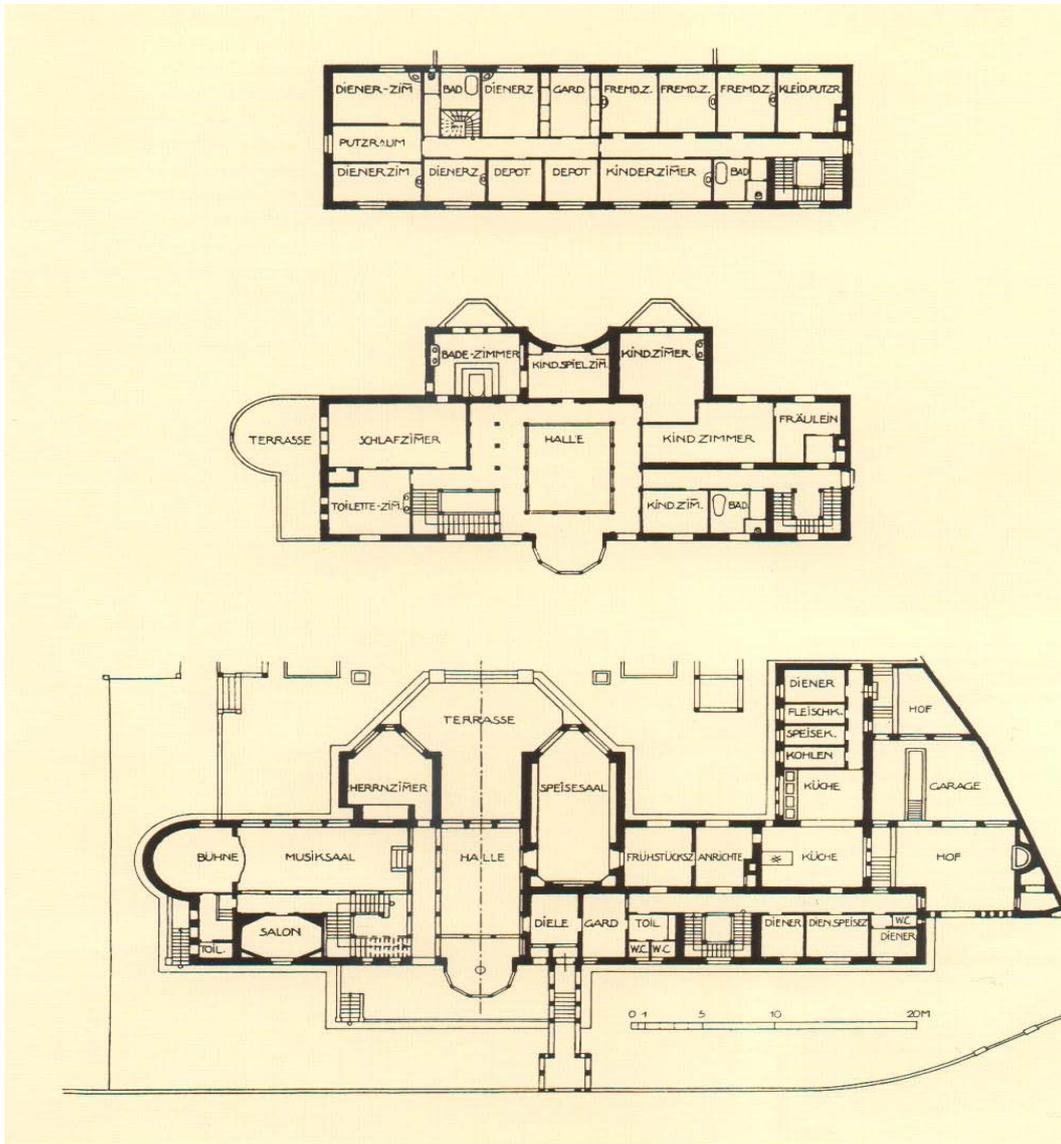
Josef Hoffmann, *Palais Stoclet, Planzeichnungen, 1905-1911*, Grundriss und Erdgeschoß, unten: Erdgeschoß, Mitte: erster Stock, oben: Obergeschoß.
